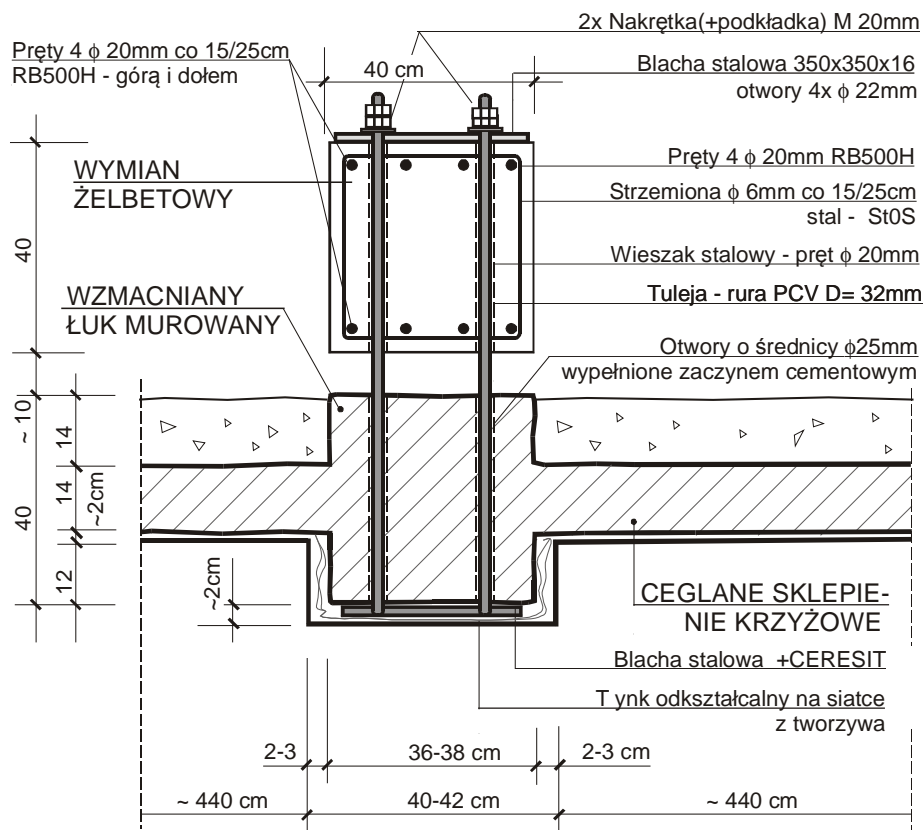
Metody rekonstrukcji uszkodzonych elementów – przekrój
